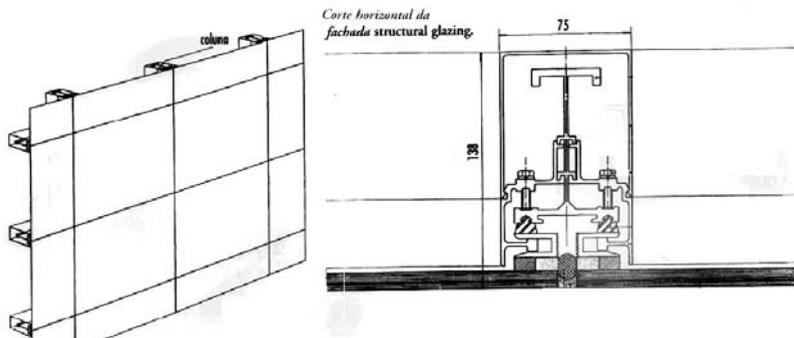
Fachada tipo structural glazing. Fonte: Corcuera (1999)
